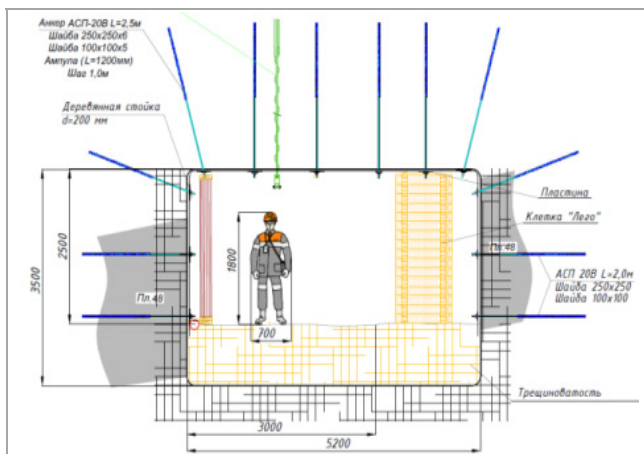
Схема усиления крепления вентиляционного штрека 2-7 с усилением деревянной податливой крепью, деревянными стойками и анкерами
